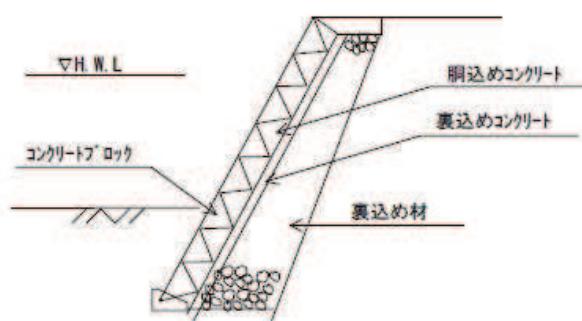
コンクリートブロック積工（輪荷重の影響・軟弱地盤等の場合）
